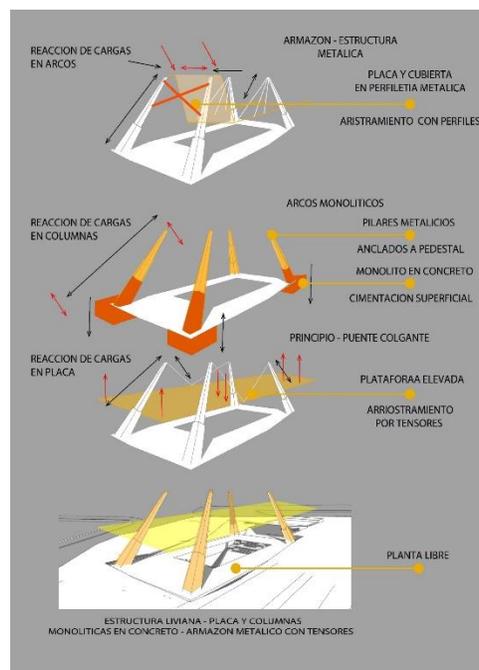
Esquema de sistema estructural Colgante Pabellón Premiere. Fuente: Elaboración propia.
